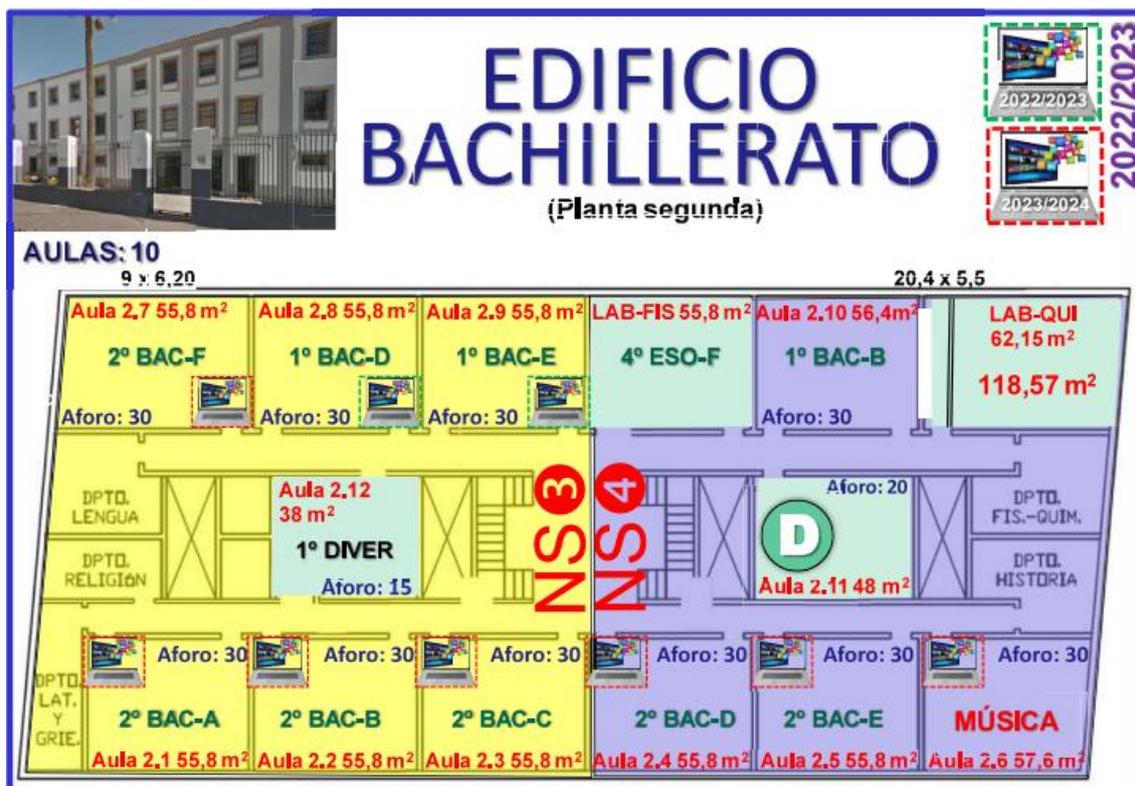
Plano del centro. Edificio de Bachillerato. Planta segunda.
